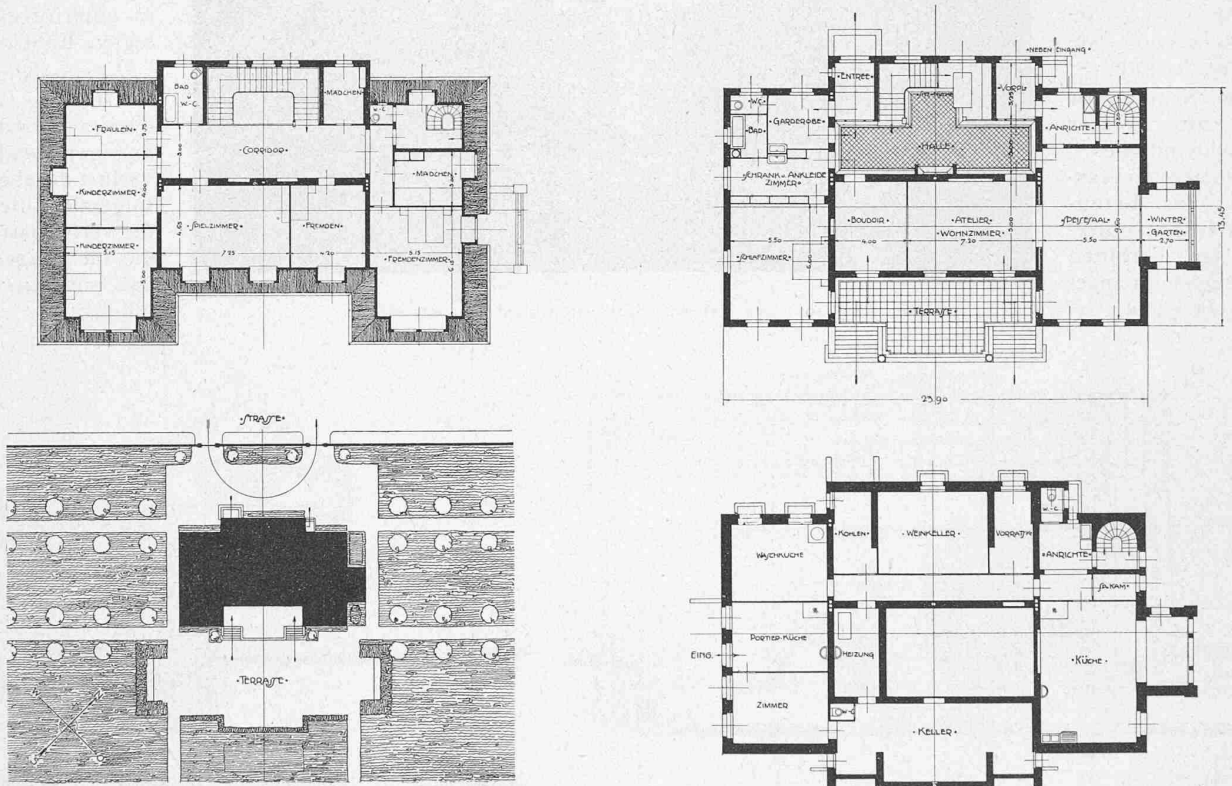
Lageplan 1 : 1000. — Landsitz von Prof. Henri Marteau. — Abb. 2 bis 4. Grundrisse 1 : 400.
